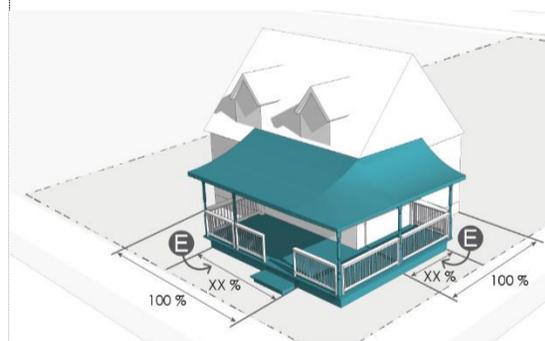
Largeur d'une façade principale occupée par une galerie couverte
